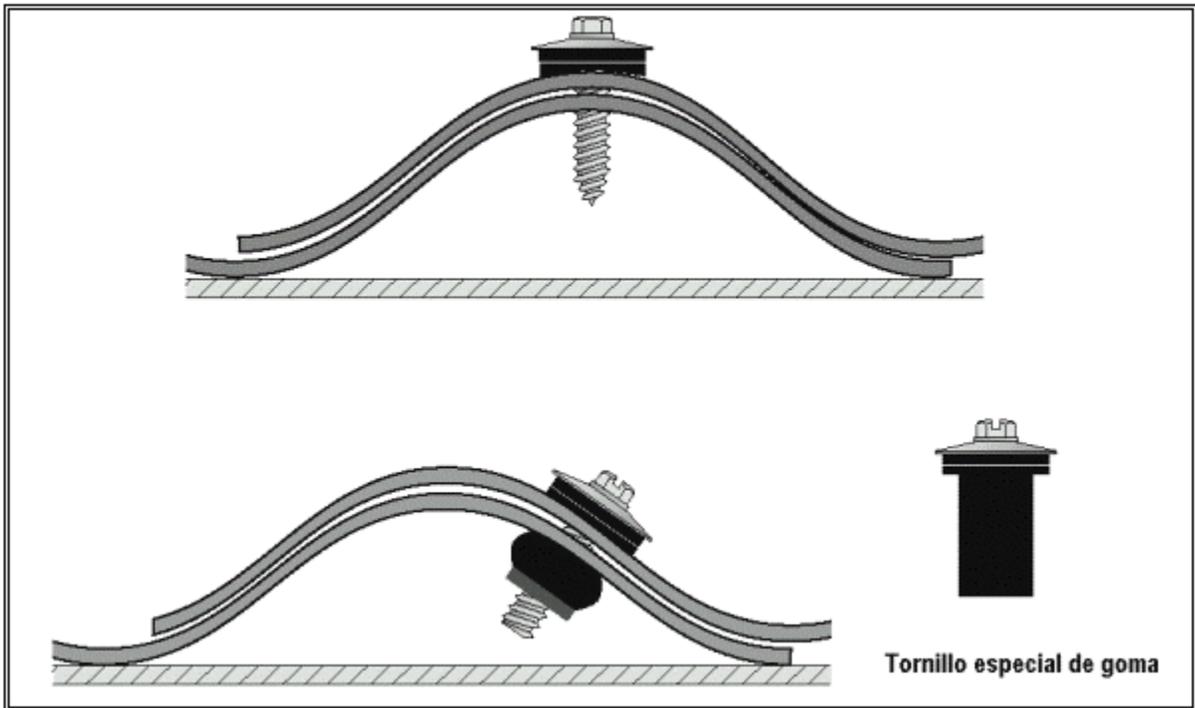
Detalle de fijación para placas traslapadas.
